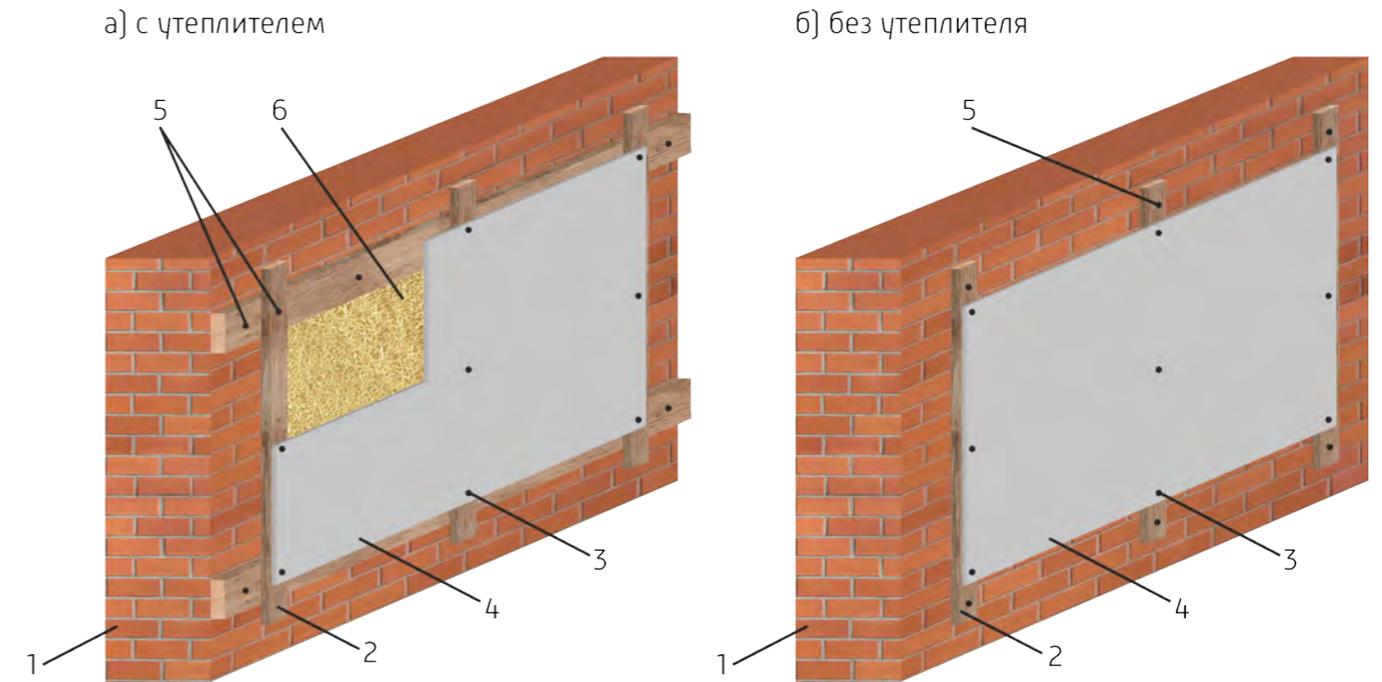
Фасад кирпичного здания из плоских хризотилцементных листов
